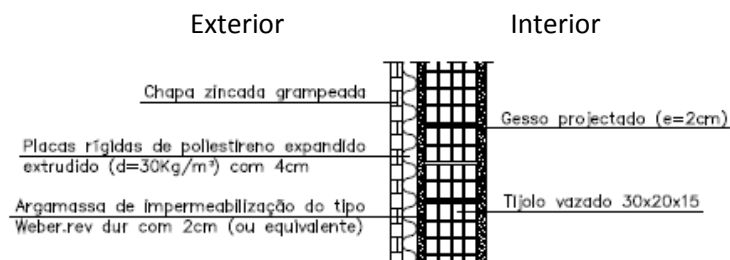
Pormenor construtivo da parede Pe2 [17]
